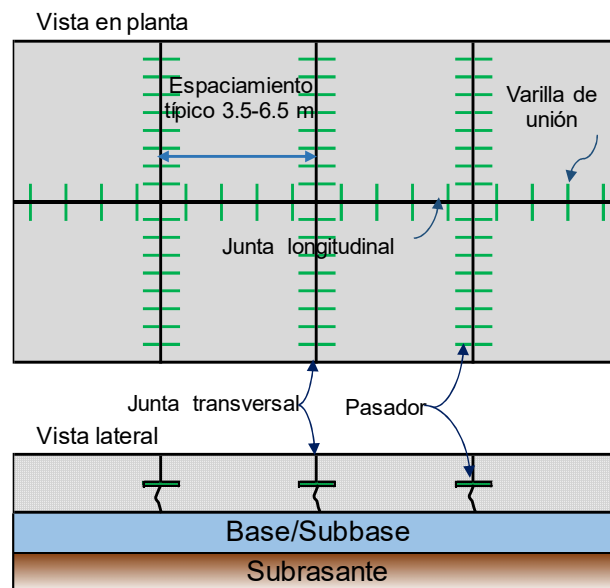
Variante 1, pavimento de concreto simple con juntas (JPCP)
